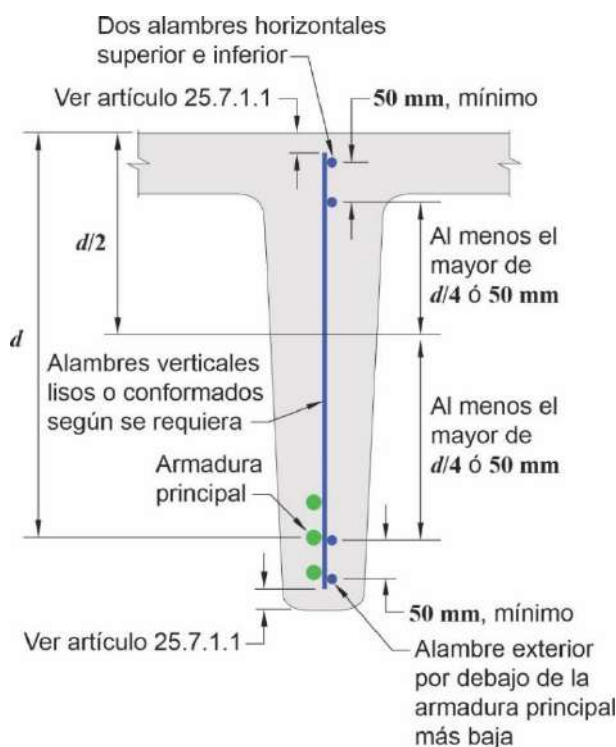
Anclaje de la armadura a corte formada por una rama de la malla de acero soldada de alambre.
